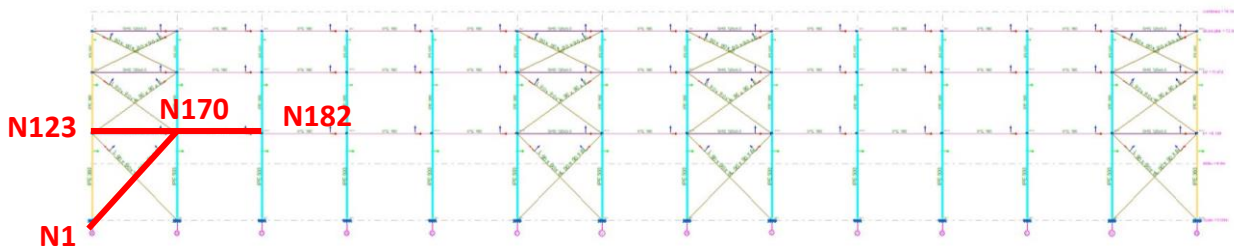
Selección de barras del pórtico de fachada lateral. Fuente: CYPE 3D.
